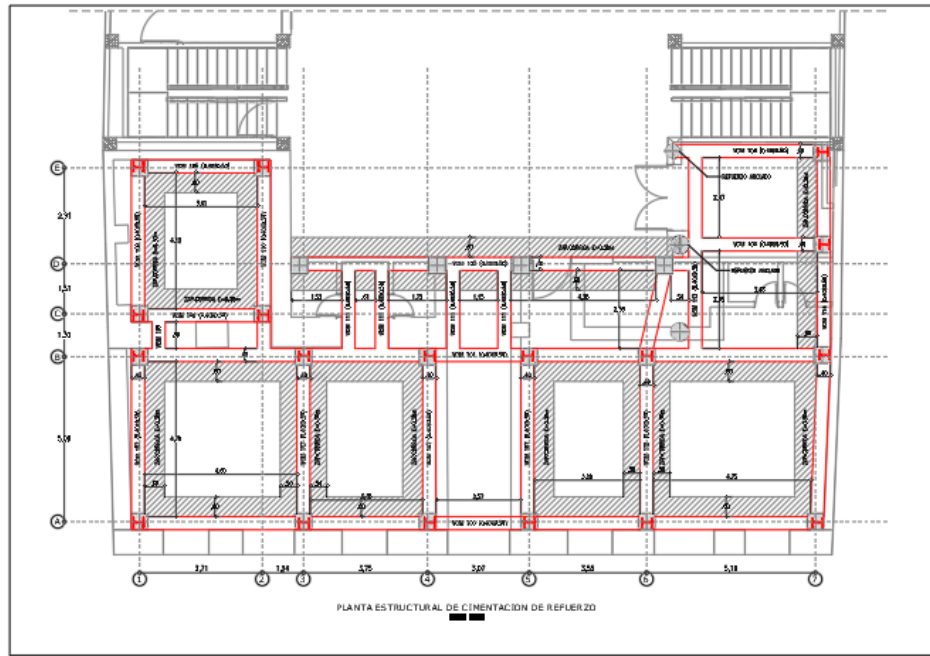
Planta de cimentación de refuerzo. Fuente. Ing. Alvaro Caballero
